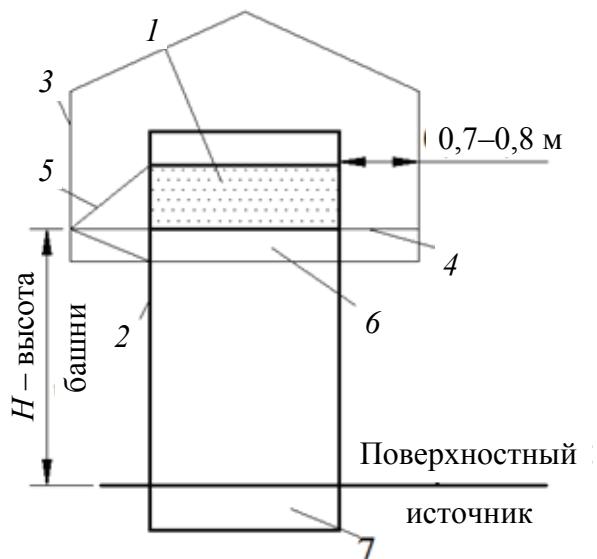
Схема устройства водонапорной башни: 1 – бак башни; 2 – поддерживающая конструкция (ствол) башни; 3 – шатер; 4 – легкое перекрытие; 5 – лестница; 6 – подбаковая камера; 7 – подвальное помещение
